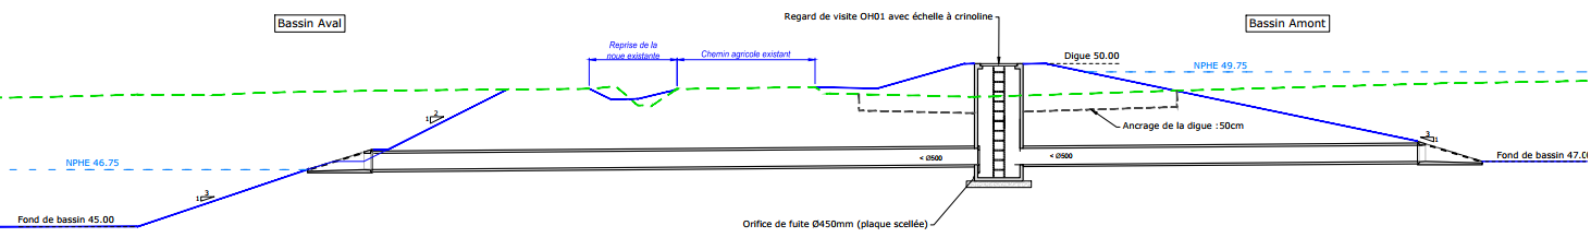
Coupe de l'ouvrage de fuite en amont (OH01)
